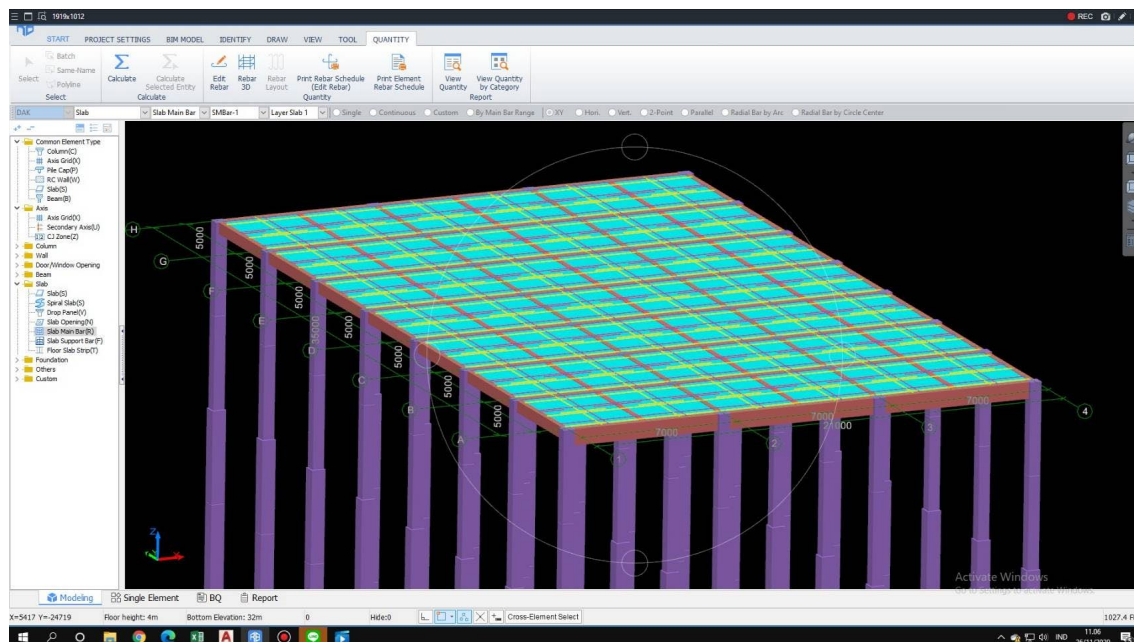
Detail penulangan pelat arah Y potongan kiri
